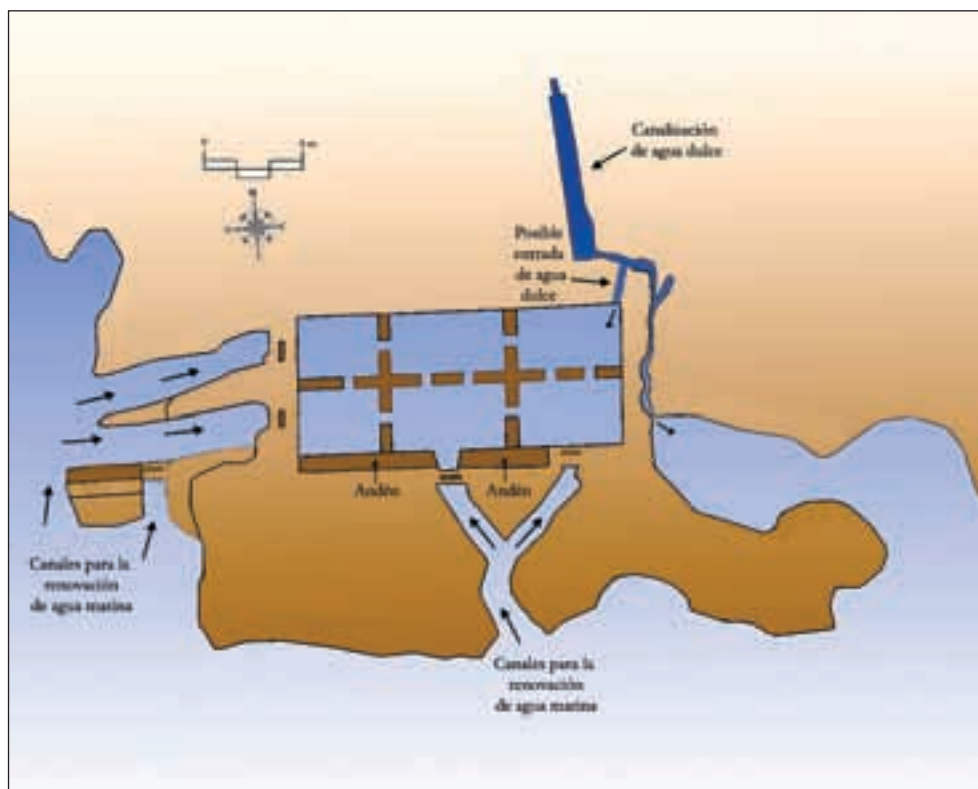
Plano del vivero de Bany's de la Reina de Calpe con indicación de los elementos constructivos principales. Plano del autor
